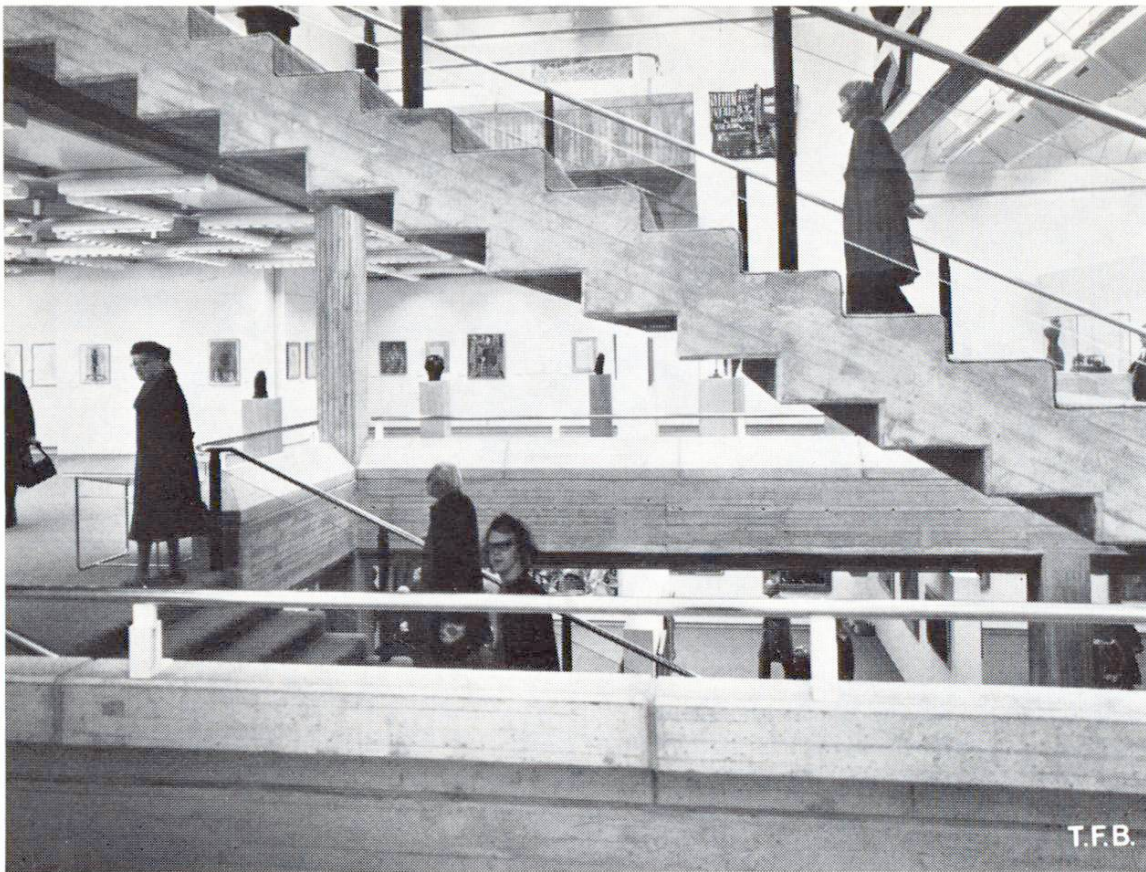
Ortsbeton im Neubau Kunsthaus Zürich
